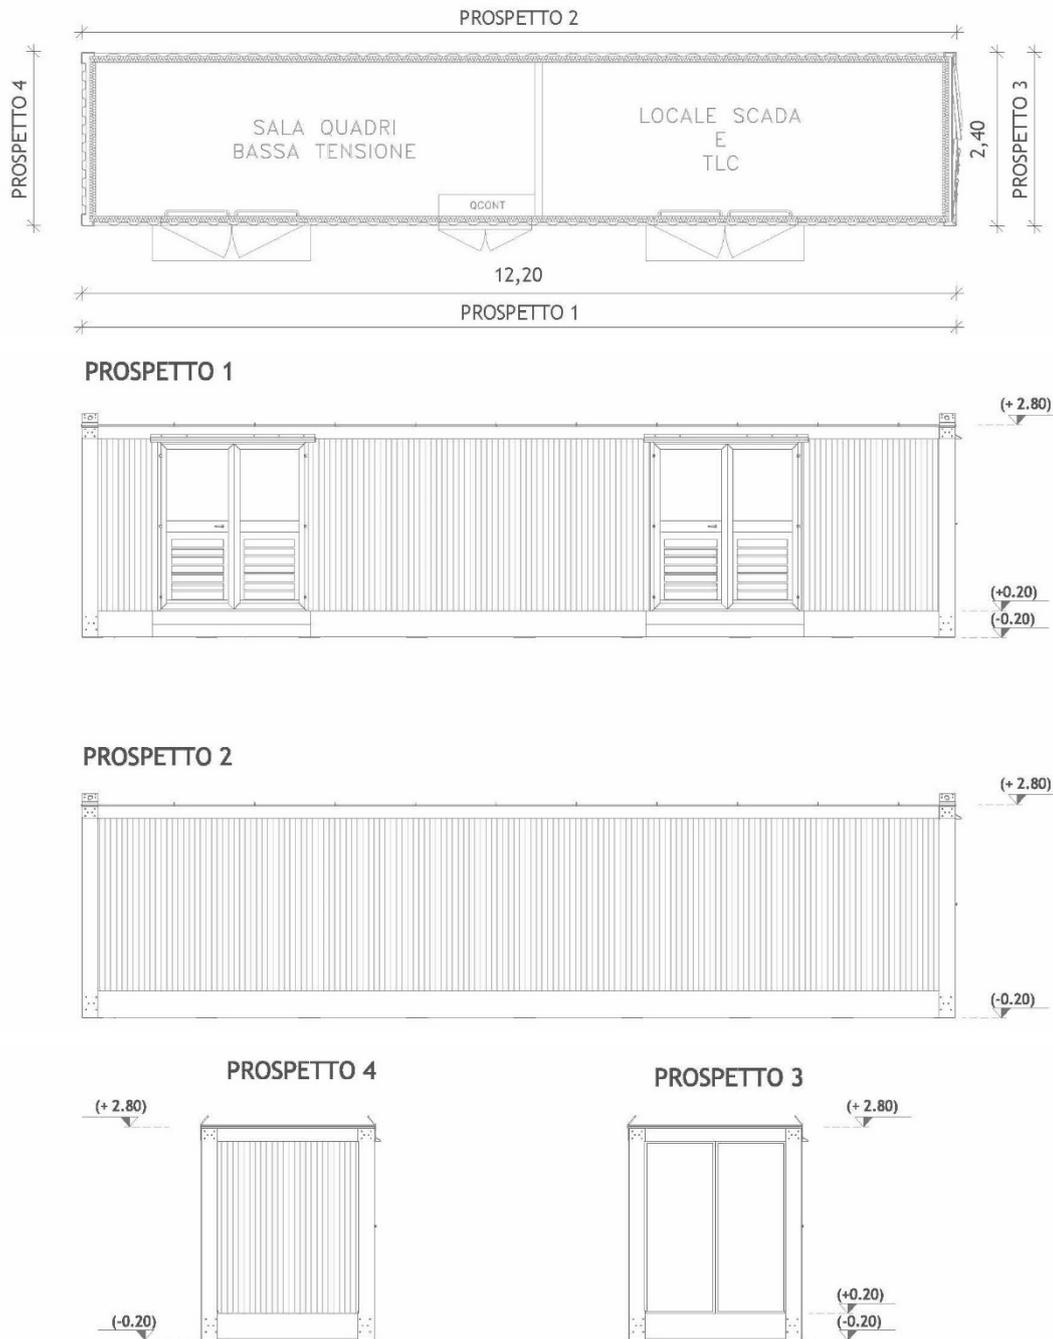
Planimetria e prospetti dell'Edificio BT + SCADA e TLC
